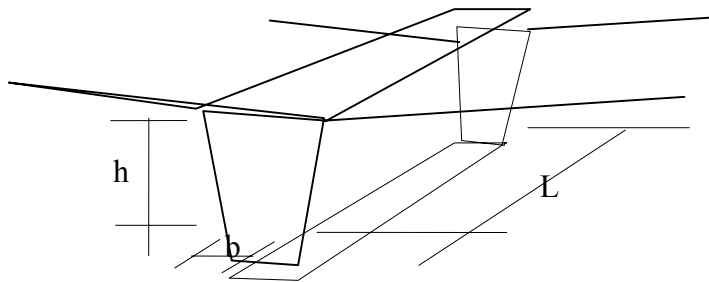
Parámetros que definen la geometría de una zanja.
